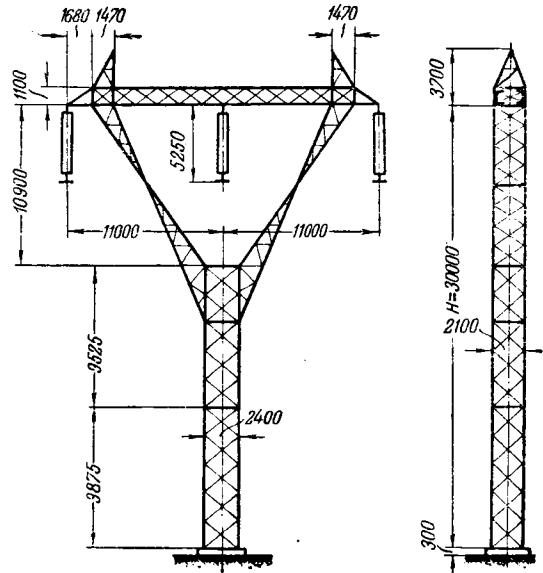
Опора типа „рюмка“ с железобетонным фундаментом.
